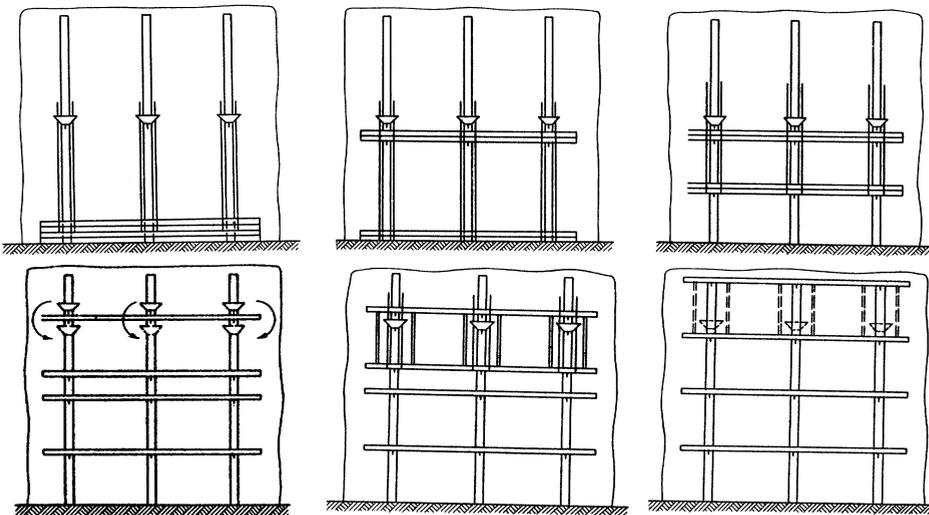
Схемы возведения сооружения (здания) методом подъема перекрытий и покрытия
